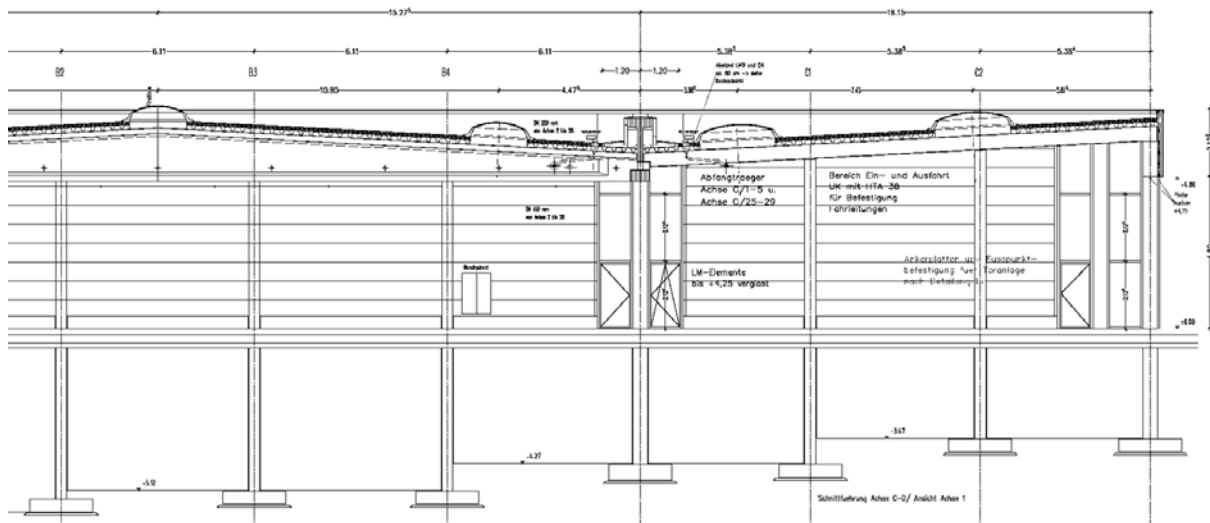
Schnitt Abstellhalle Bau 1 BT 1 in Nord-Süd-Richtung (Nordbereich)
